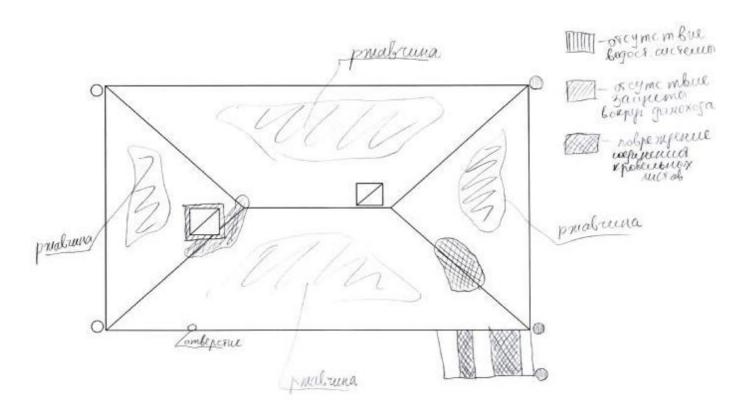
Дефектная карта кровли (здание рис.1,2).
